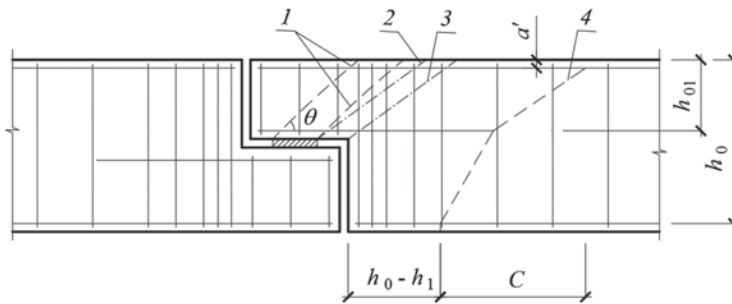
Расположение расчетных наклонных сечений для расчета конструкций с подрезками:
